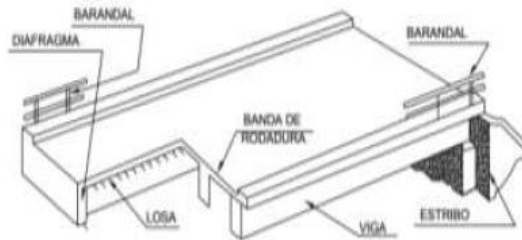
ELEMENTOS CON PESO MUERTO EN UN PUENTE.
